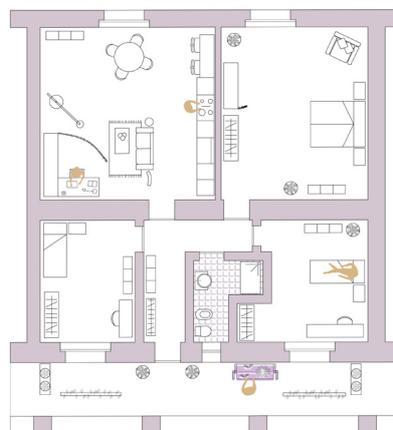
Rappresentazione planimetrica appartamento Casa Ballatoio con arredi.
